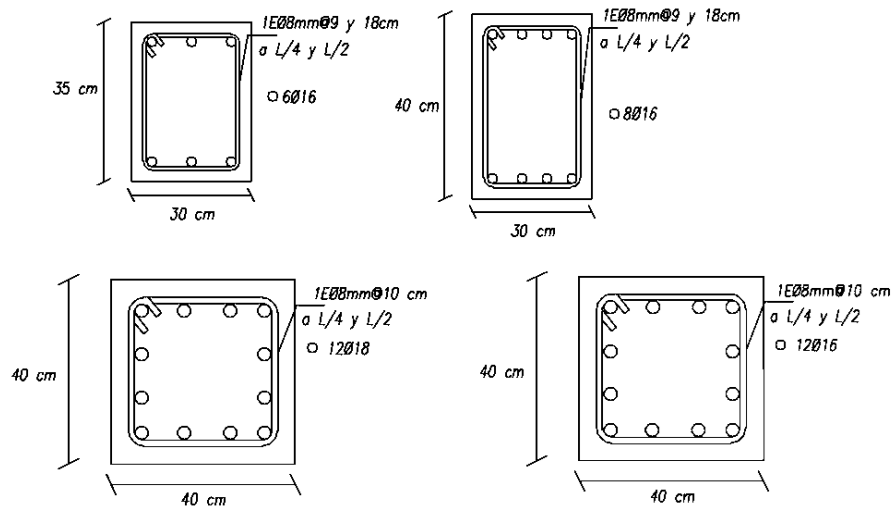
Dimensiones mínimas ACI para vigas y columnas necesarias para las luces propuestas.
